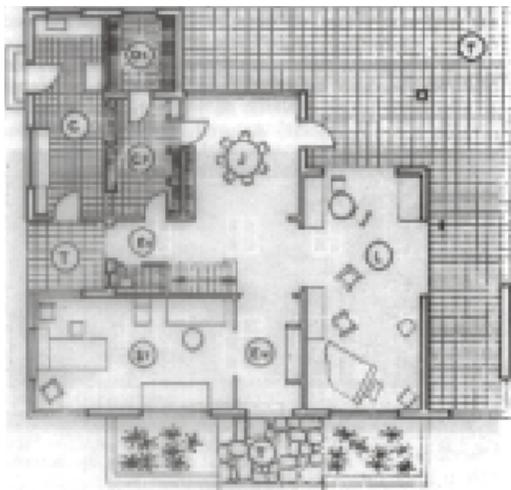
Gregori Warchavchic , Casa do Arquiteto, Planta baixa do pavimento térreo, 1927 – 1928, São Paulo.
